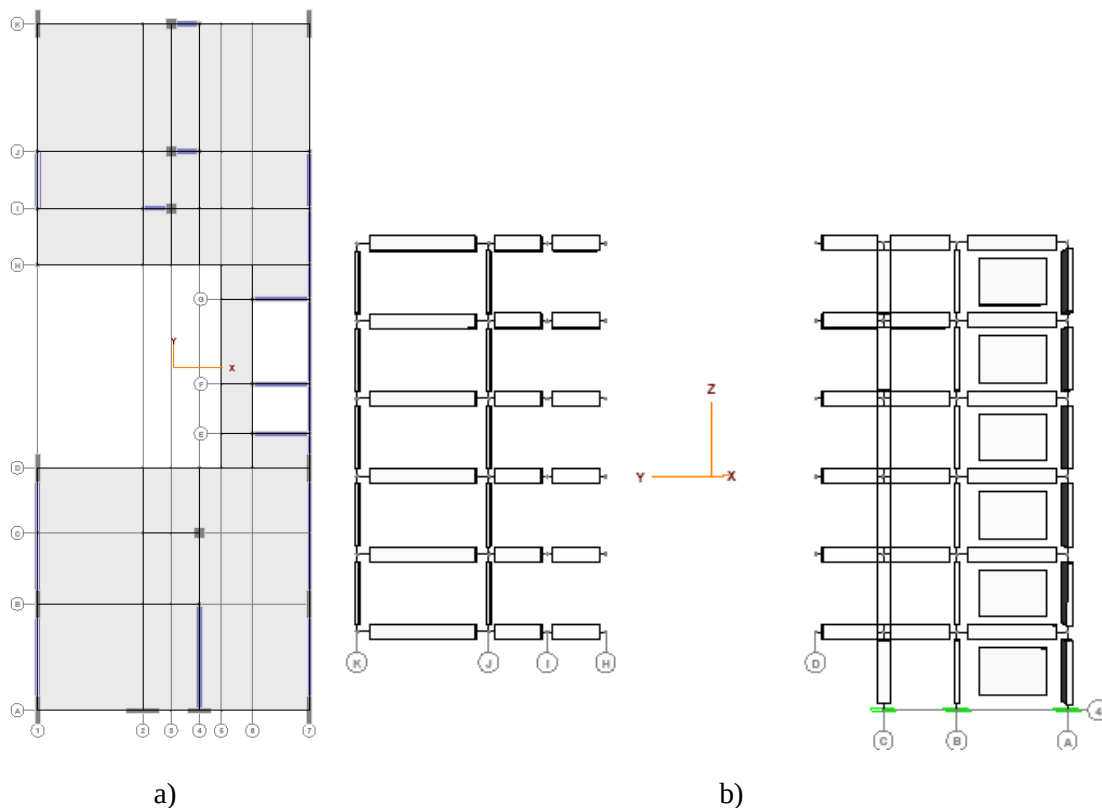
a) Vista en planta primer nivel, b) Vista en elevación, corte longitudinal
